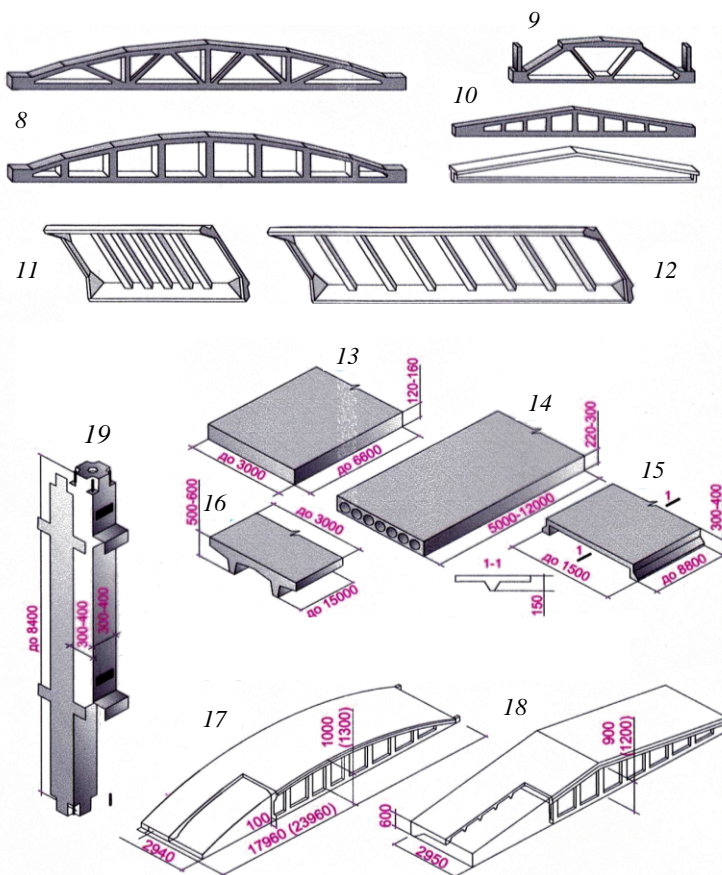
Изделия из бетона и железобетона (Окончание):
